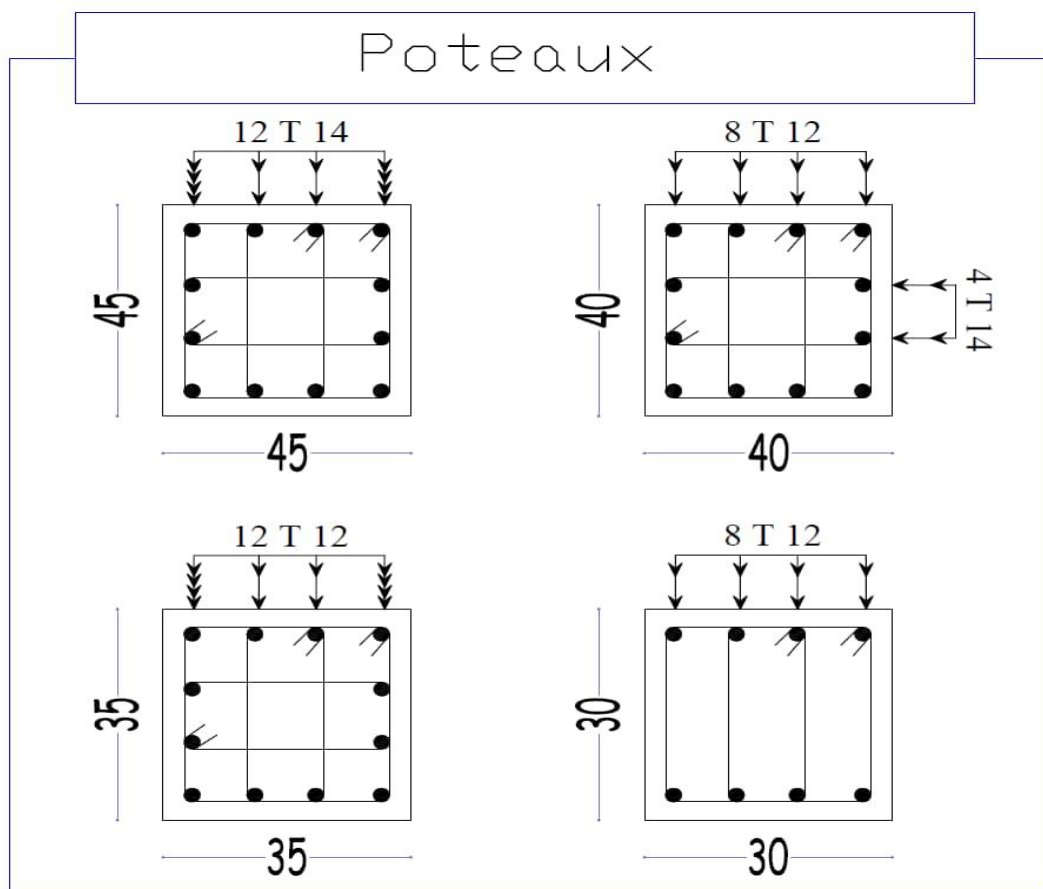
Ferrailage des poteaux.VI.3. Etude des voiles :
